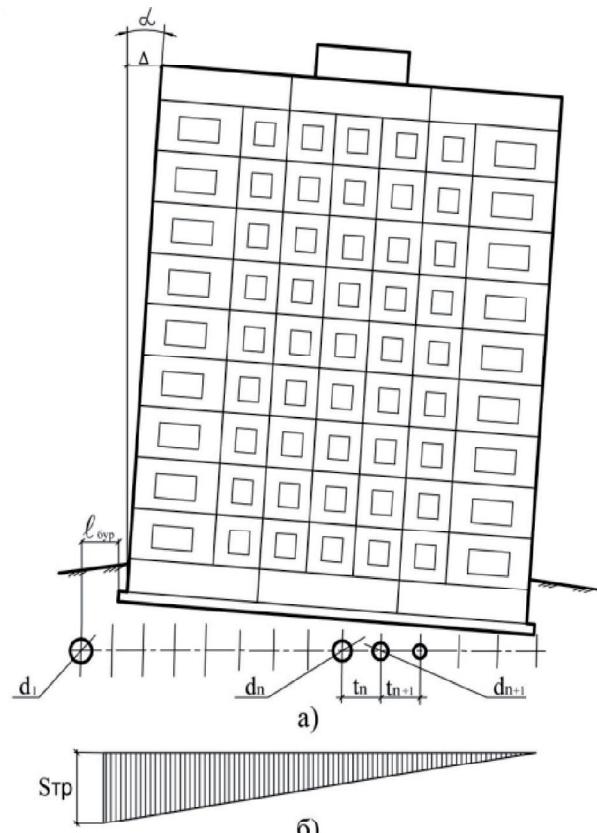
Технологическая схема устранения крена здания в продольном направлении: а) параметры крена здания и технологических скважин; б) эпюра осадок фундаментов; α - угол наклона здания; Δ - отклонение от вертикали здания; S_{tp} – технологическая осадка здания; d, t – переменные параметры шага и диаметра скважин.
